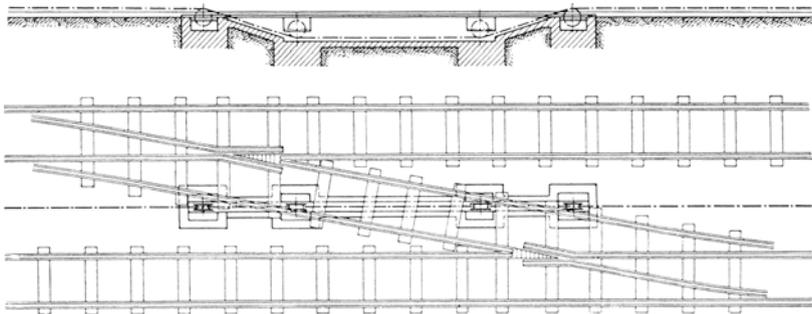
u. 343. Seilunterführung bei einer Weiche.
